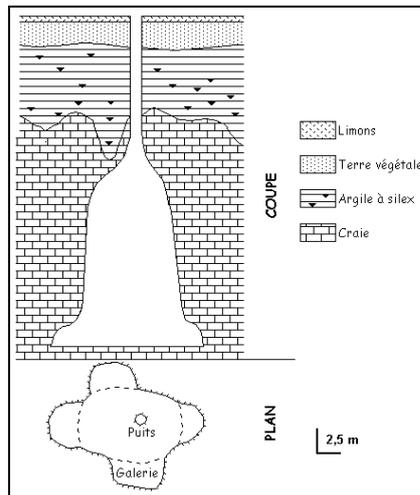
Schéma d'une marnière en bouteille [Adam et al, ouvrage à paraître]
